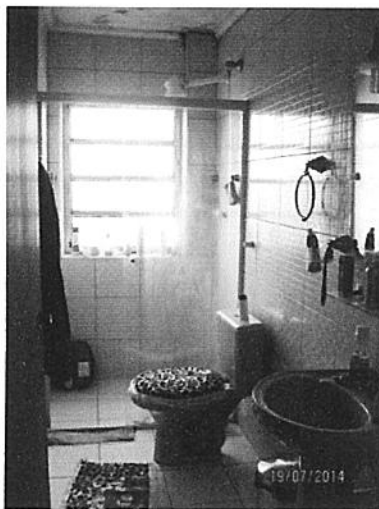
Vista do banheiro com acabamento similar ao da cozinha.
